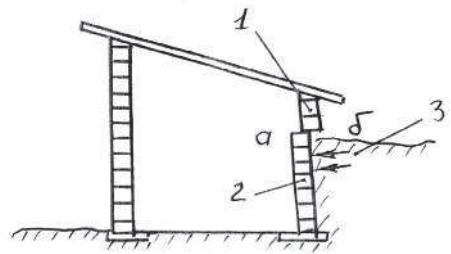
Разрушение стенки гаража: 1, 2 – разрушение части стены; 3 – грунт
